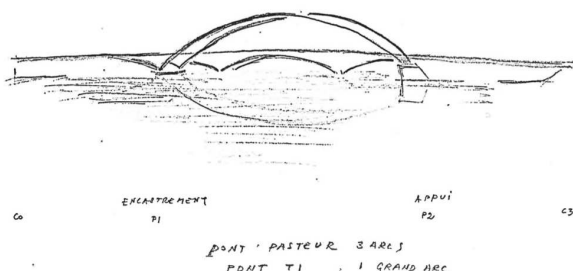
Croquis pont Raymond Barre devant pont Pasteur
